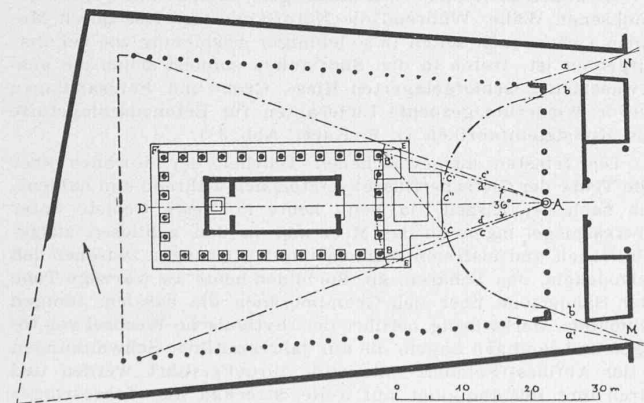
Römischer Tempel von Palmyra, 1. Jahrhundert v. Chr. Grundriss 1 : 1000
